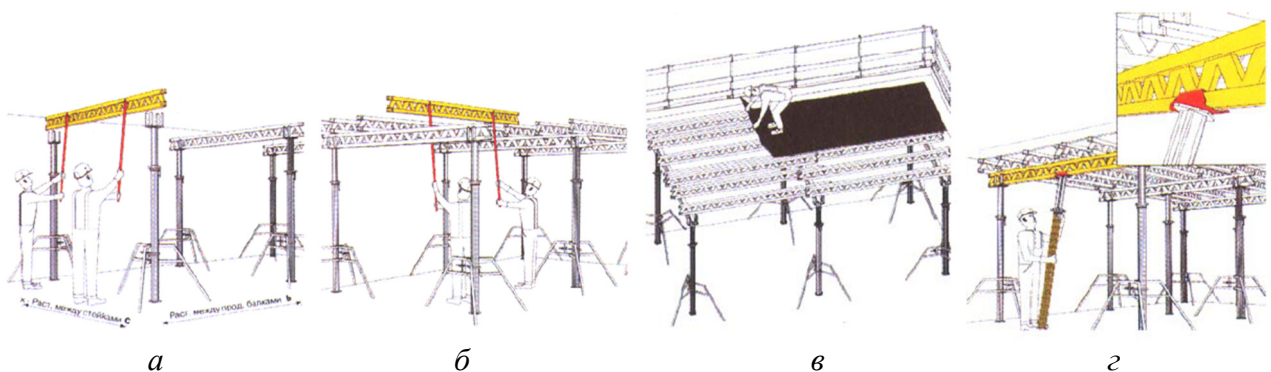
Последовательность монтажа горизонтальной опалубки:
